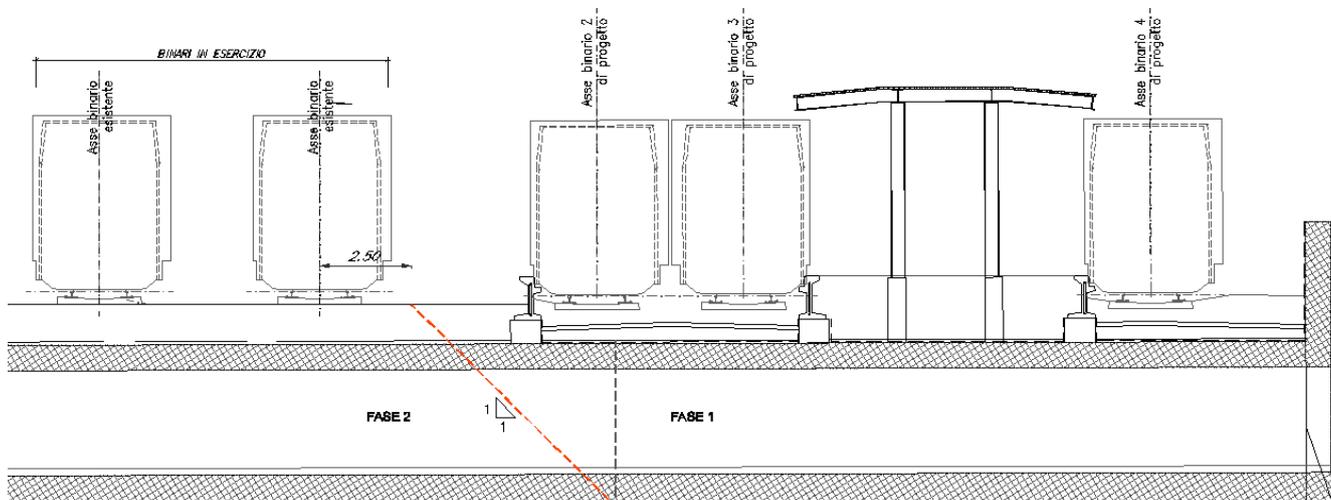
SEZIONE LONGITUDINALE DEL SOTTOPASSO DA PD CON INDICAZIONE DELLE FASI ESECUTIVE
